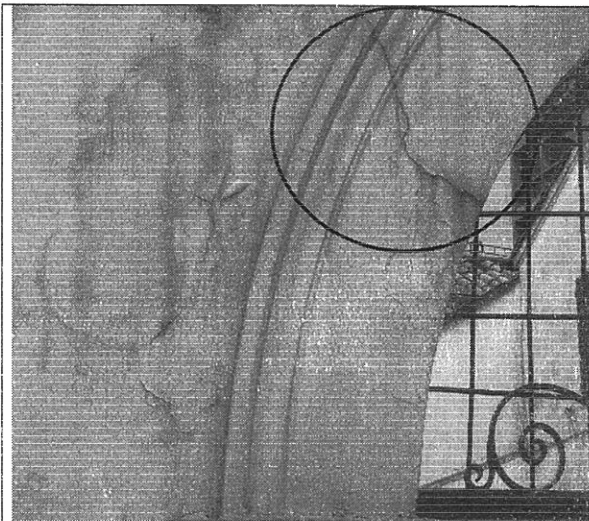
Fisura en el arco de la puerta de ingreso
